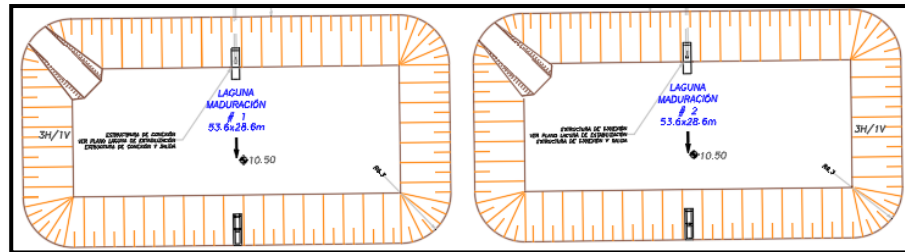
Plano de la situación actual de las lagunas de maduración
